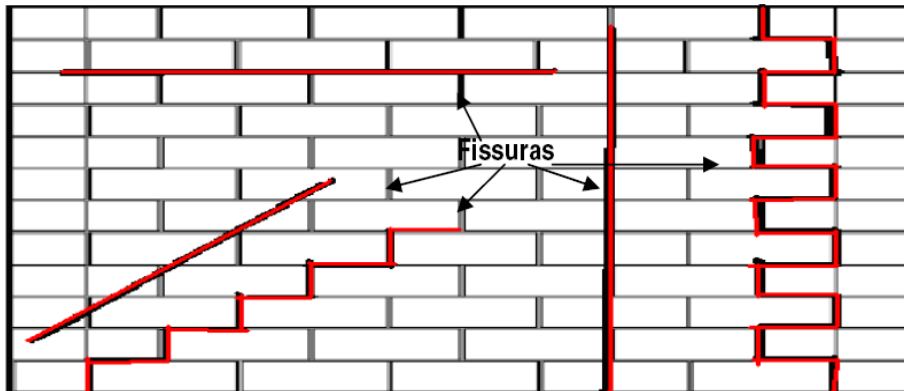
As diversas direções de fissuras em paredes de alvenaria.
